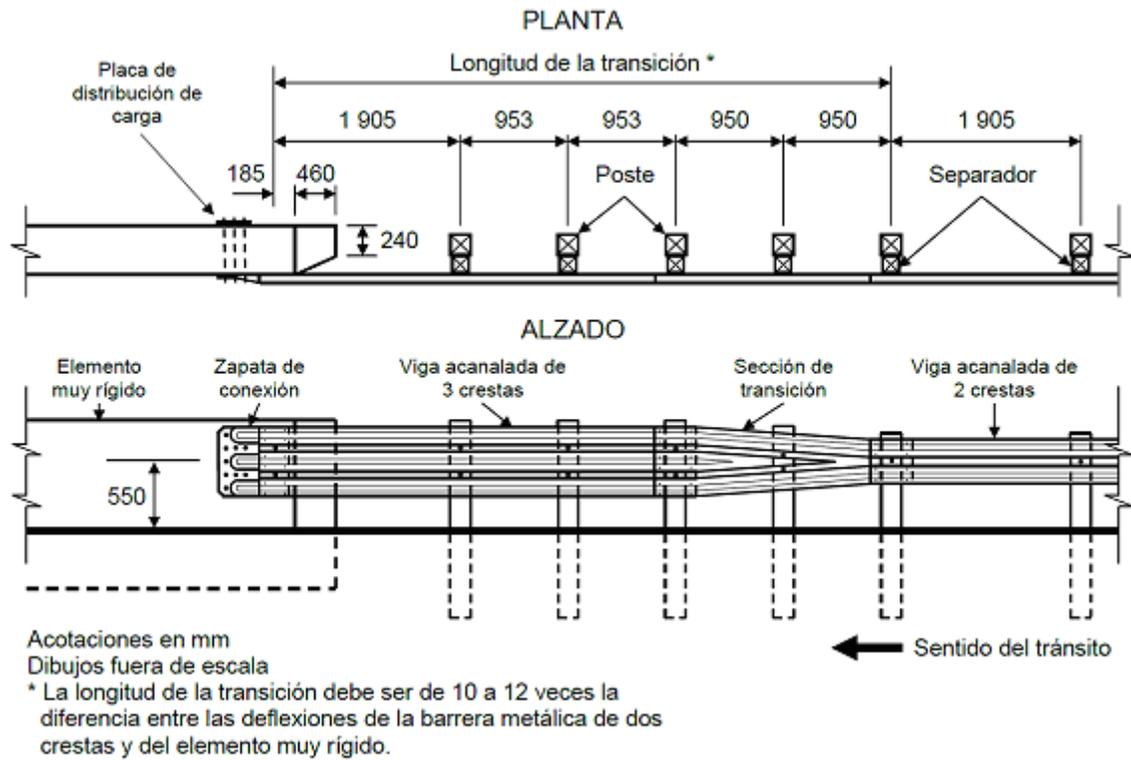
Transición de barrera metálica de dos a tres crestas y muro vertical recto
